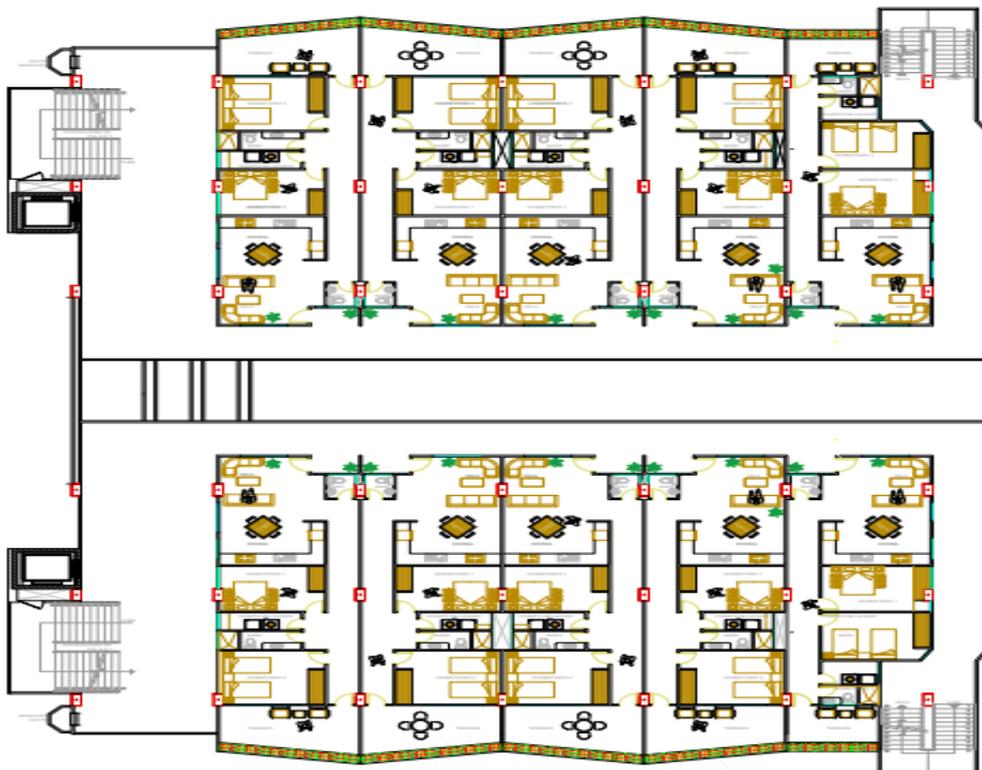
Planta Tipo del piso 2 al 5 de propuesta
